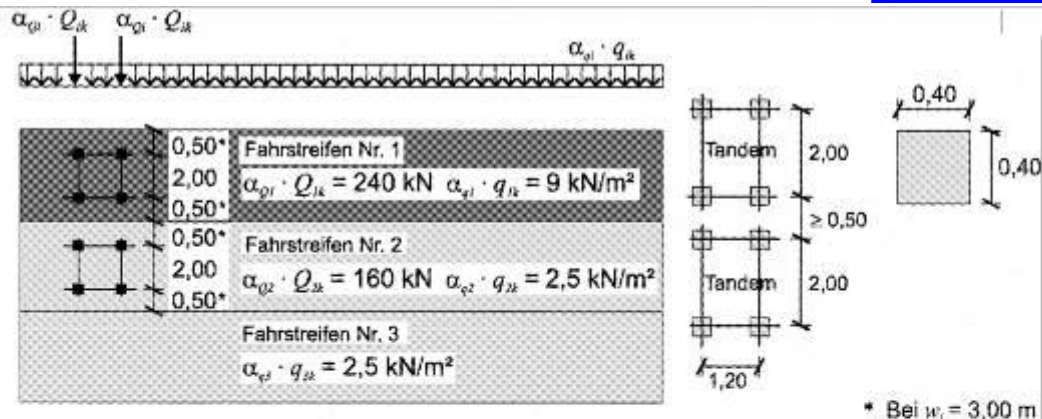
Lastmodell 1 (angepasste Grundwerte)
